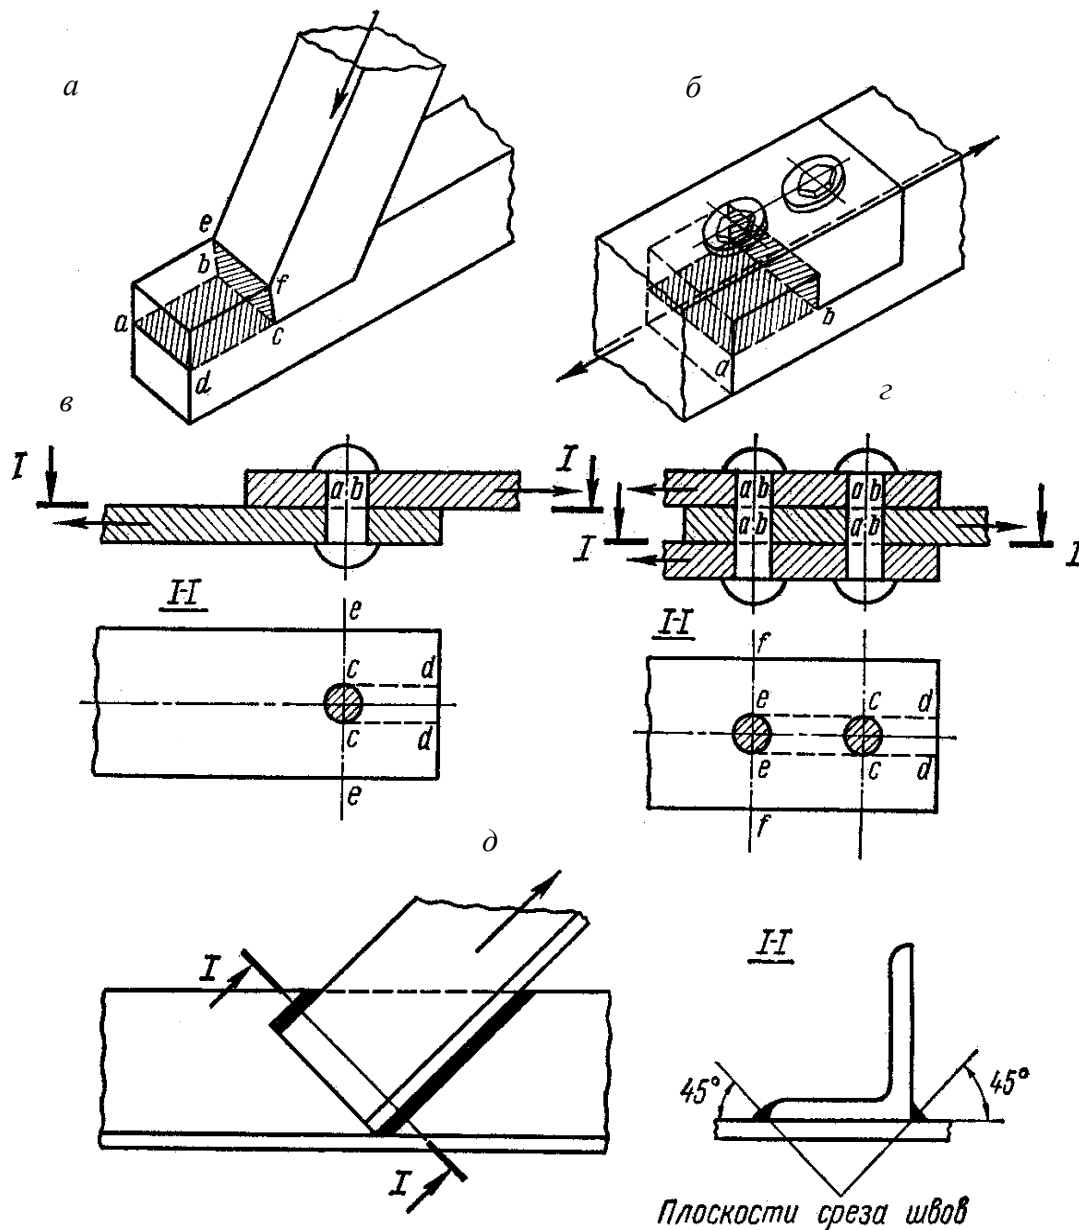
Конструкции, рассчитываемые на сдвиг: а, б – деревянная врубка; в, г – заклепочное соединение; д – сварное соединение
